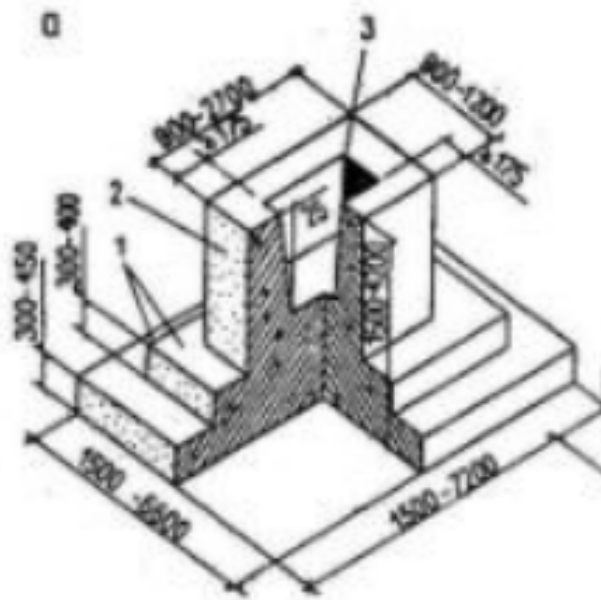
Монолітний стаканний залізобетонний фундамент
